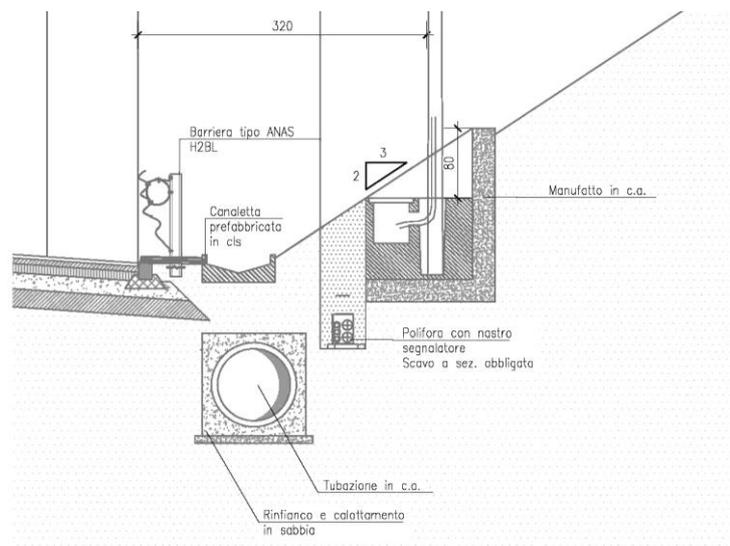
Protezione di progetto rampe tratti bordo laterale in sterro
